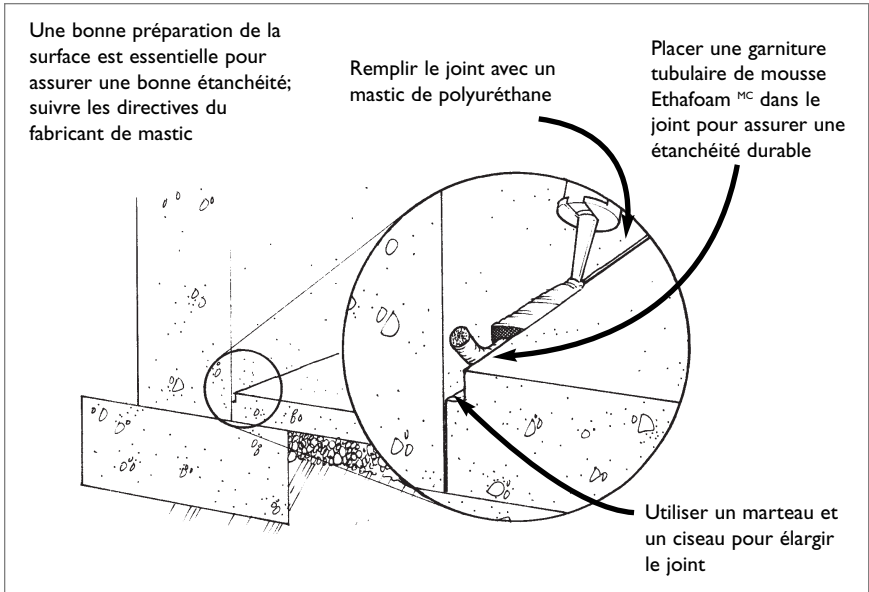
Obturation des joints des murs de fondation et des planchers du sous-sol
